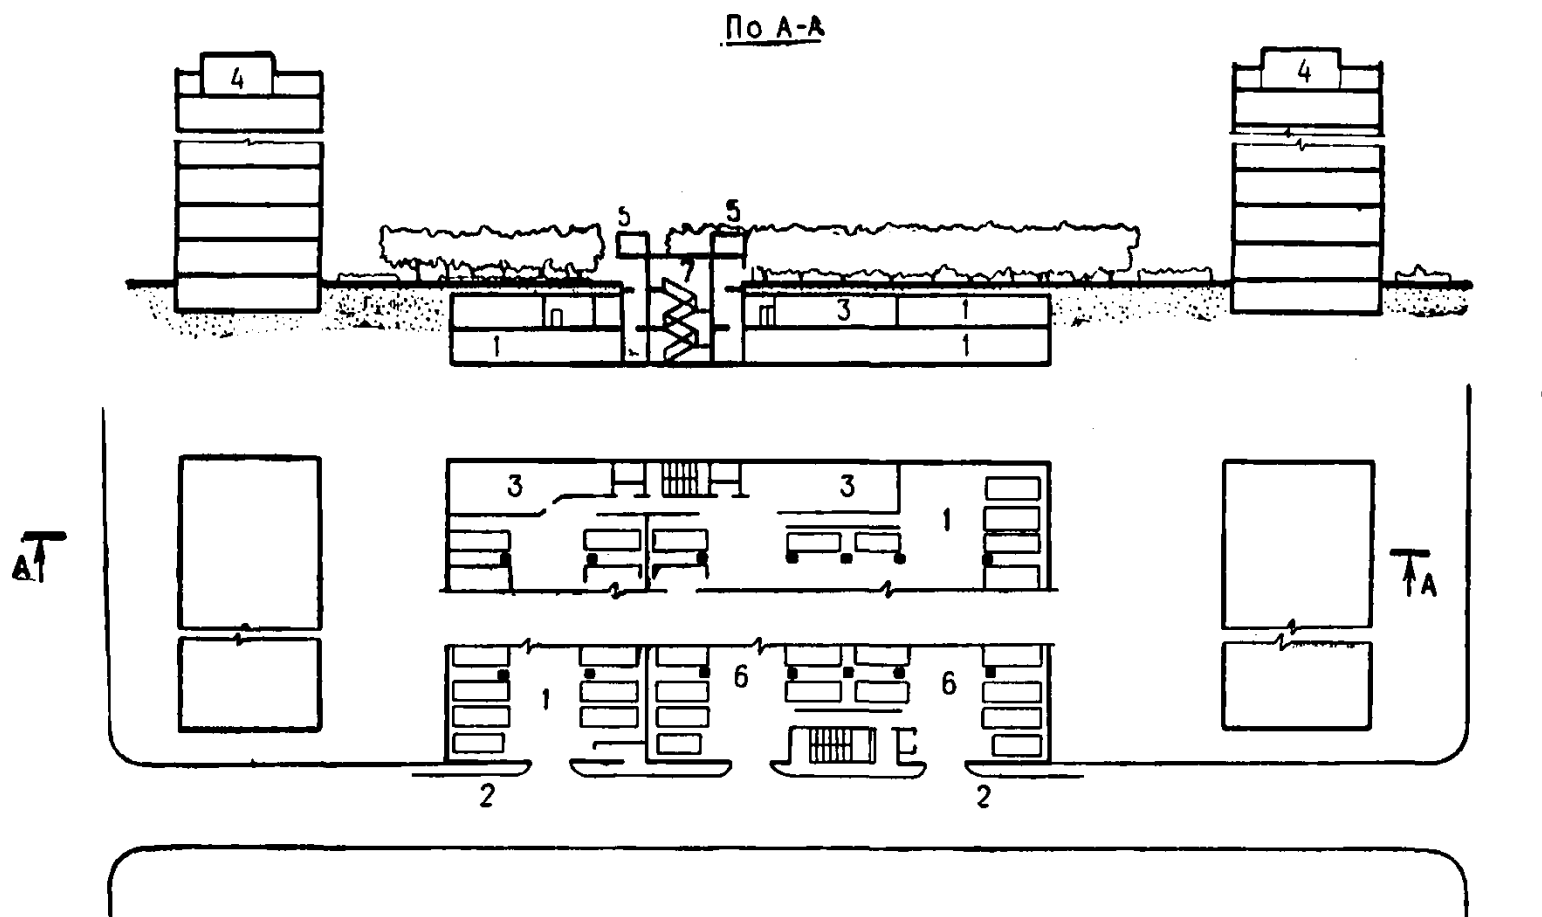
Схематический разрез и план подземного гаража-стоянки, размещенного между жилыми домами
